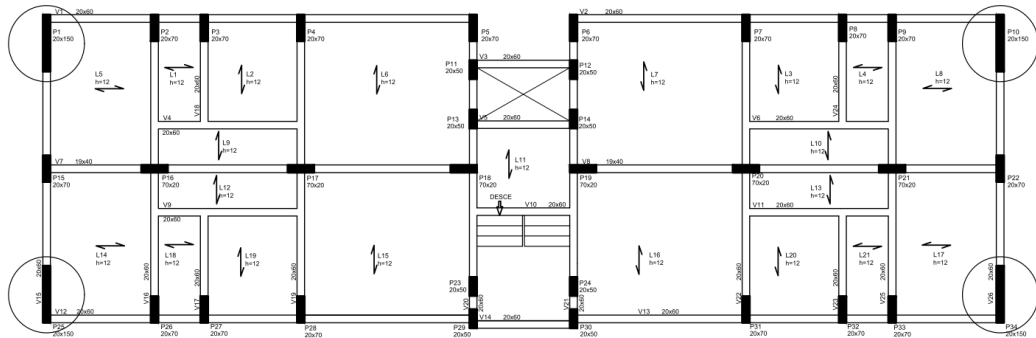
Planta tipo Caso 2.1 – 4 pilares-em-parede equidistantes e periféricos
